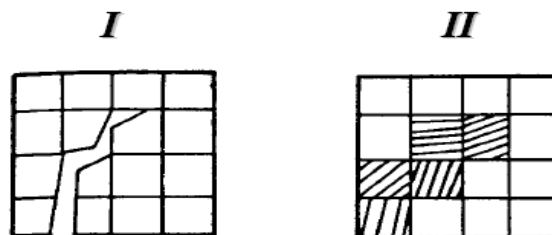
Modelos de fissuração I) Fissuras discretas II) Fissuras distribuídas (AURICH, 2001)
